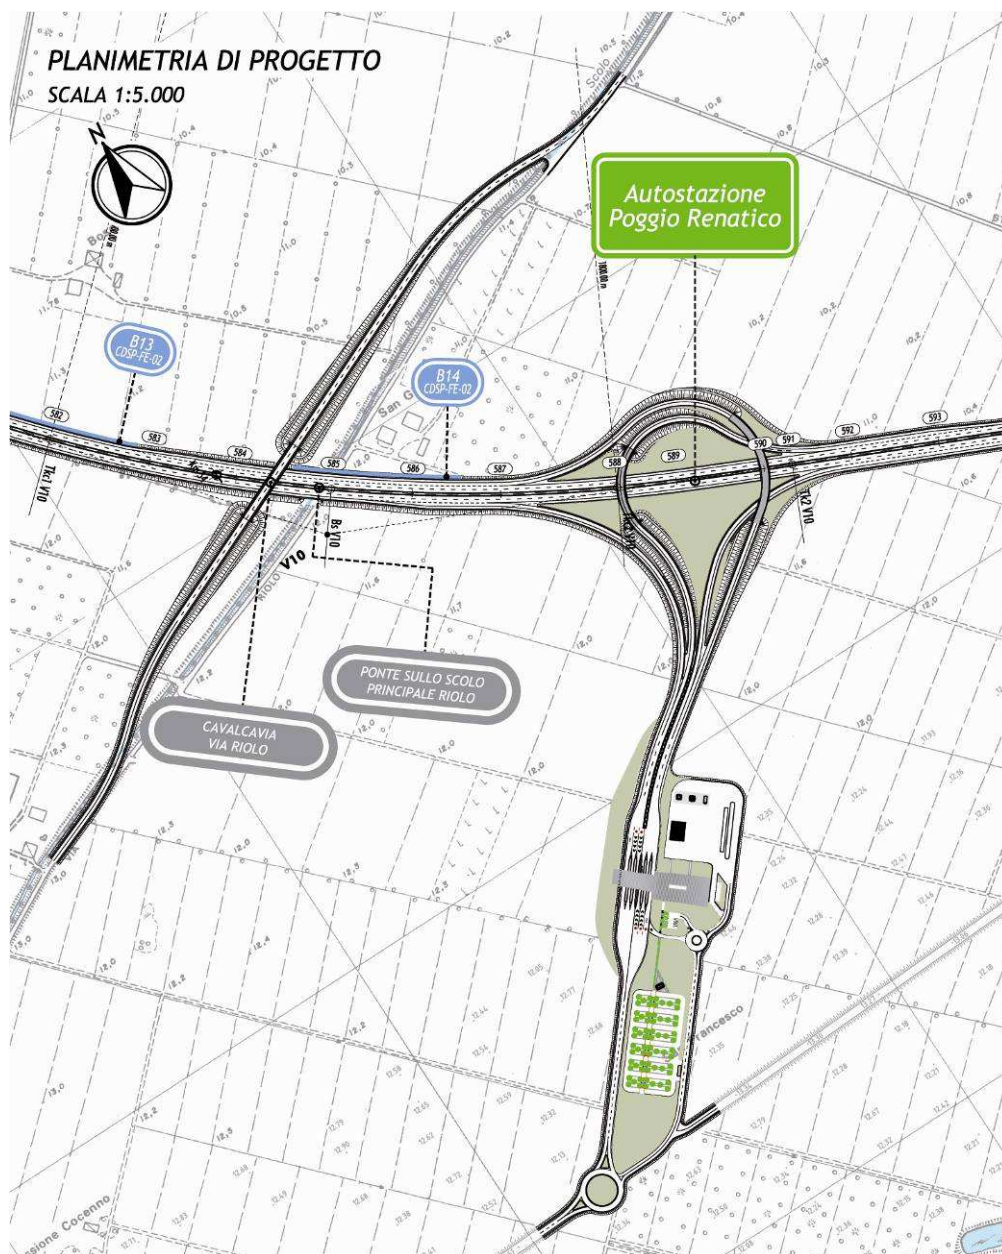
SCHEMA PLANIMETRICO SVINCOLO DI AUTOSTAZIONE TIPO
